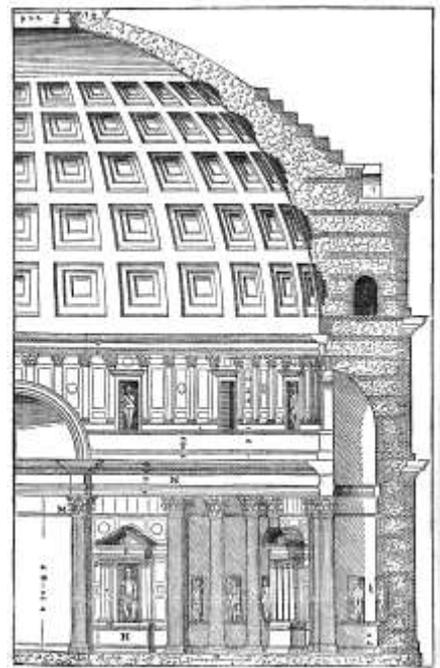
Coupe du Panthéon, Andrea Palladio.⁷³
